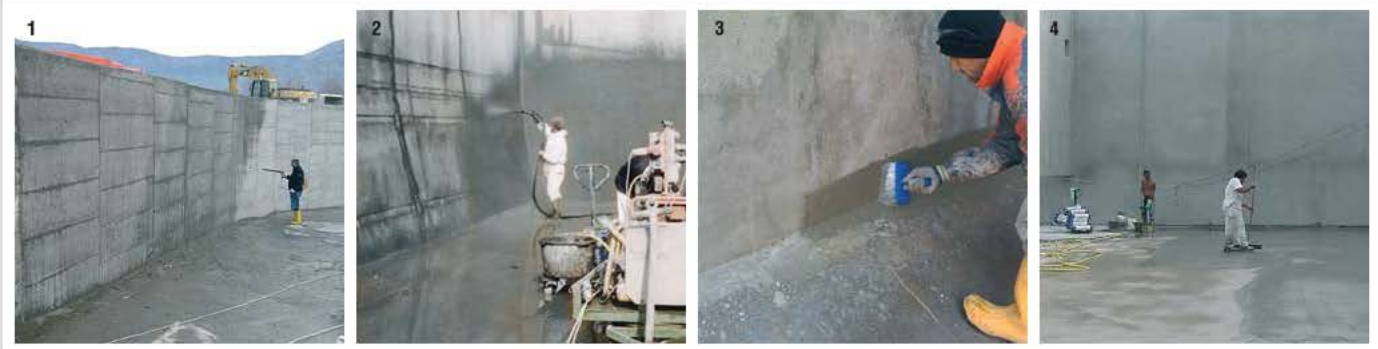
Nettoyage et lavage du support - Photo 2) Application par pulvérisation - Photo 3) Application au pinceau - Photo 4) Application à la brosse
